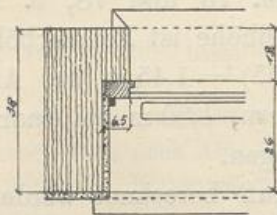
Anschlag für einfaches Fenster 6,5 cm breit.
